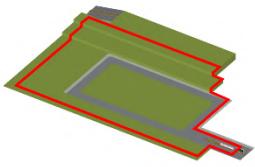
15 Rencana Blok Massa 2 Lantai 1 dan 2
